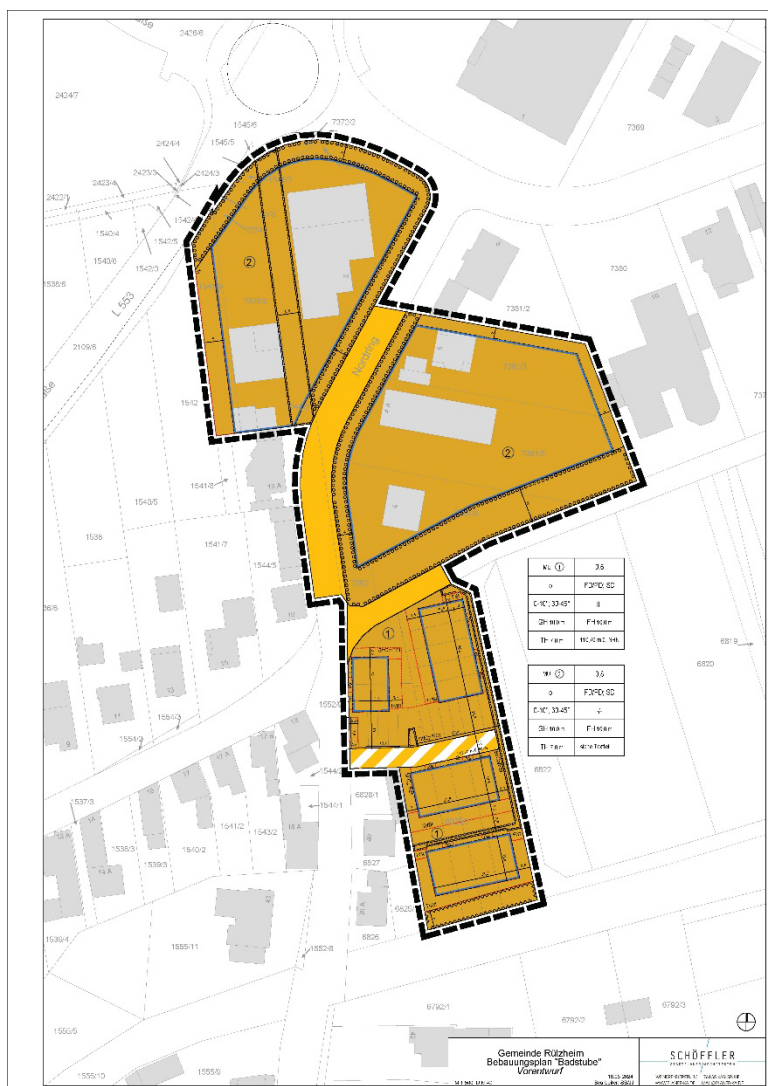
Bebauungsplan "Badstube", Vorentwurf (Schöffler Stadtplaner Architekten)
